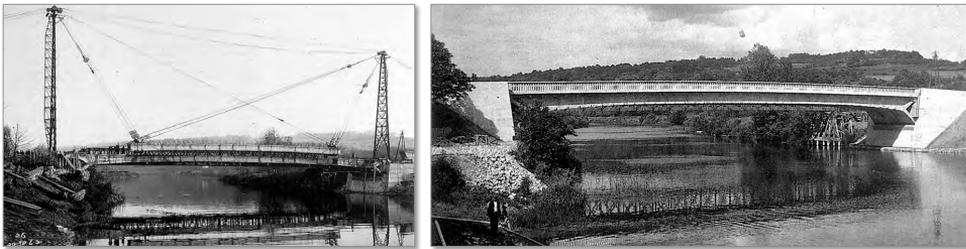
Puente de Luzancy de 54 m de luz sobre el río Marne, durante y después de su construcción. Se emplearon dovelas prefabricadas montadas por pretensado formando las vigas que se colocan entre los pilares triangulares.
